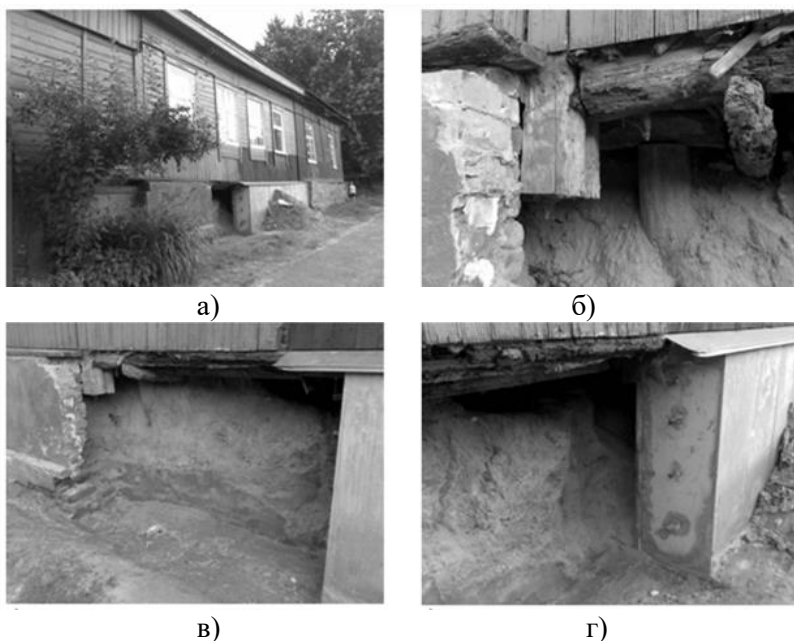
Заміна старого цегляного фундаменту на залізобетонний:
